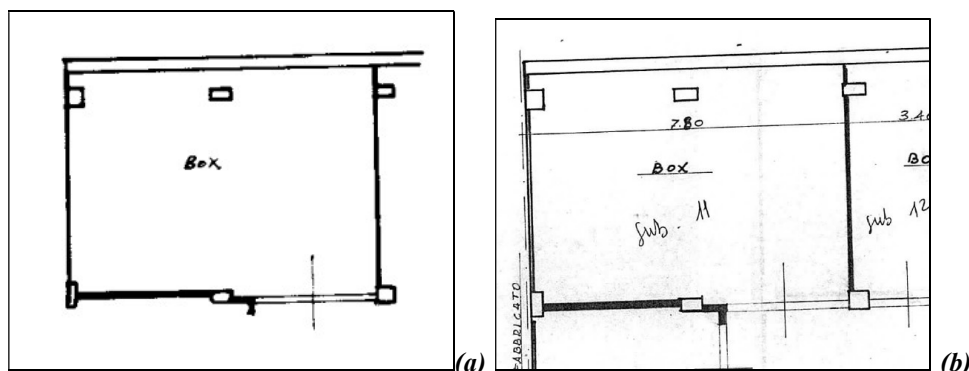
Planimetrie del locale box in piano interrato ubicato in via Leonardo Cera senza numero civico – interno 2: planimetria catastale (a); planimetria di progetto (b).
